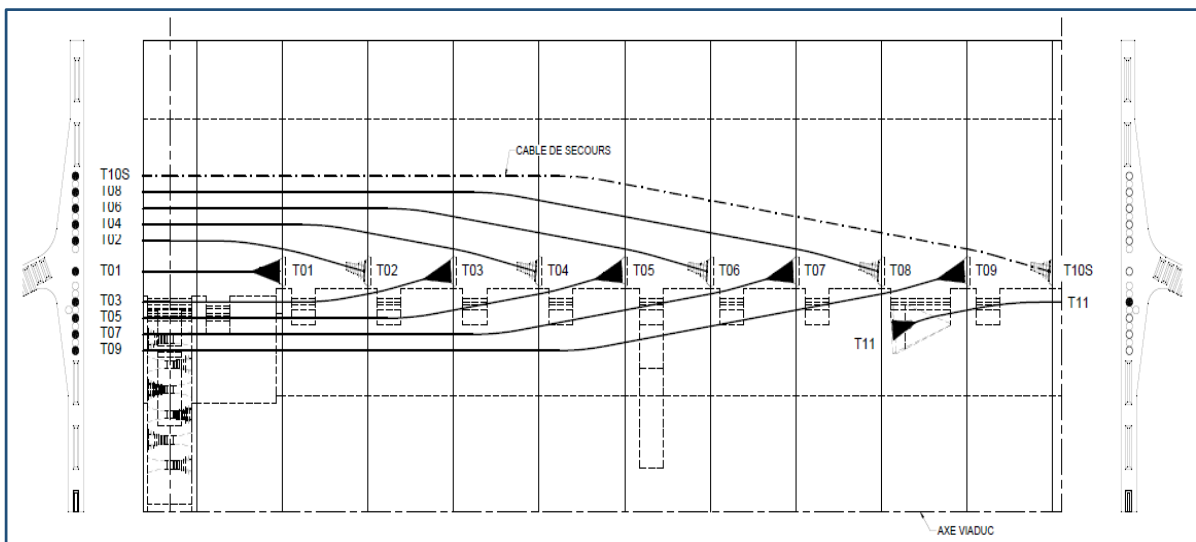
Tracé des câbles en plan d'un demi-fléau de la travée typique
